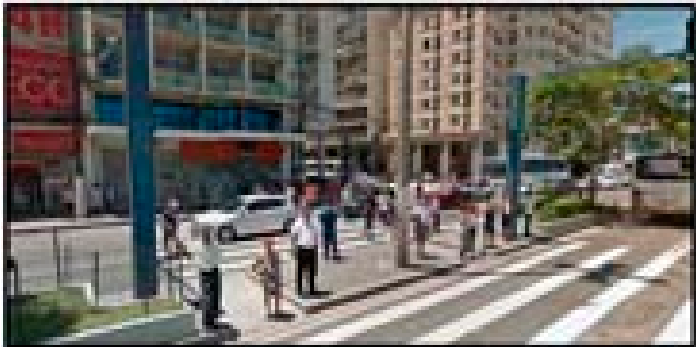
Vista parcial do local da passagem subterrânea da Av. Visconde do Rio Branco em frente a Av. Ernani do Amaral Peixoto.
